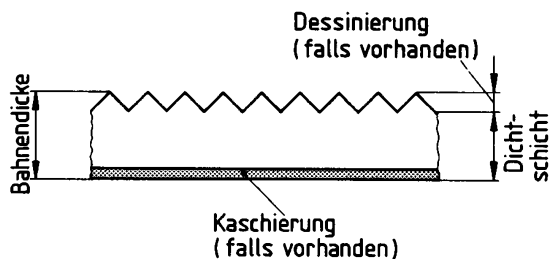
Querschnitt der Elastomer-Bahn mit einseitiger Dessinierung
